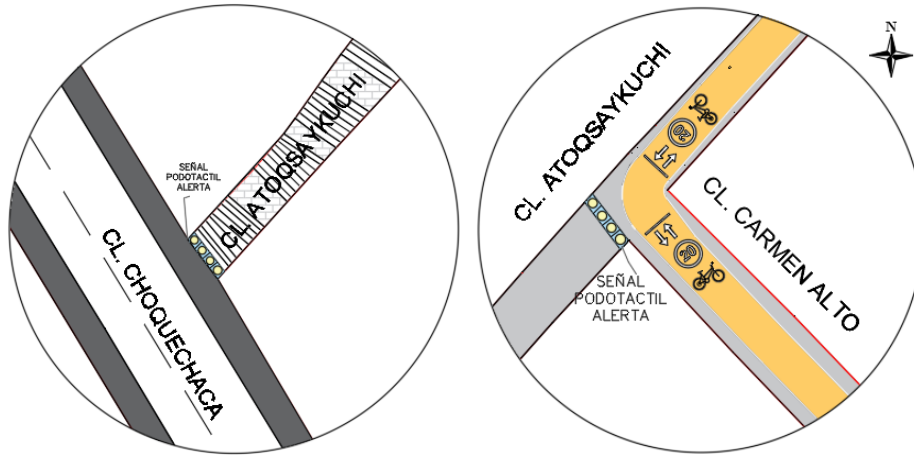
Pavimento táctil de alerta en la calle Atoqsaycuchi
